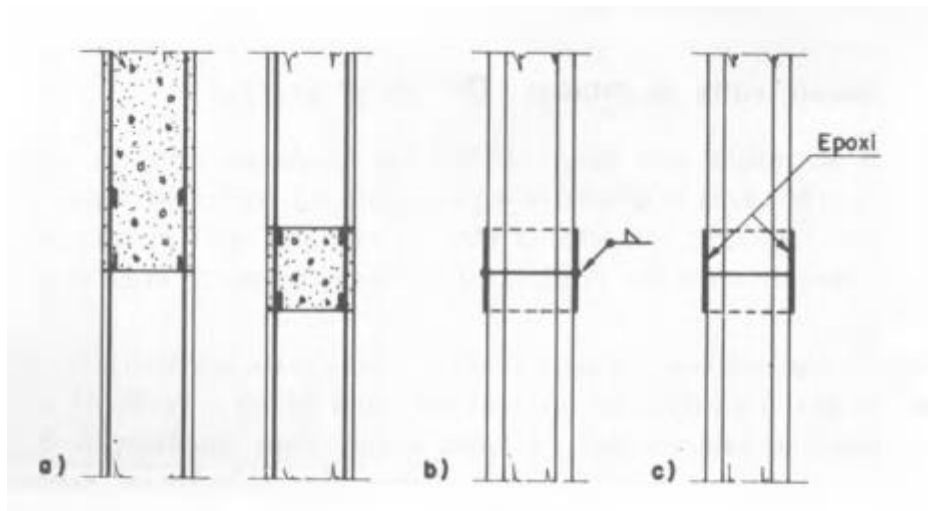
Emendas de estacas de concreto pré-moldado.
